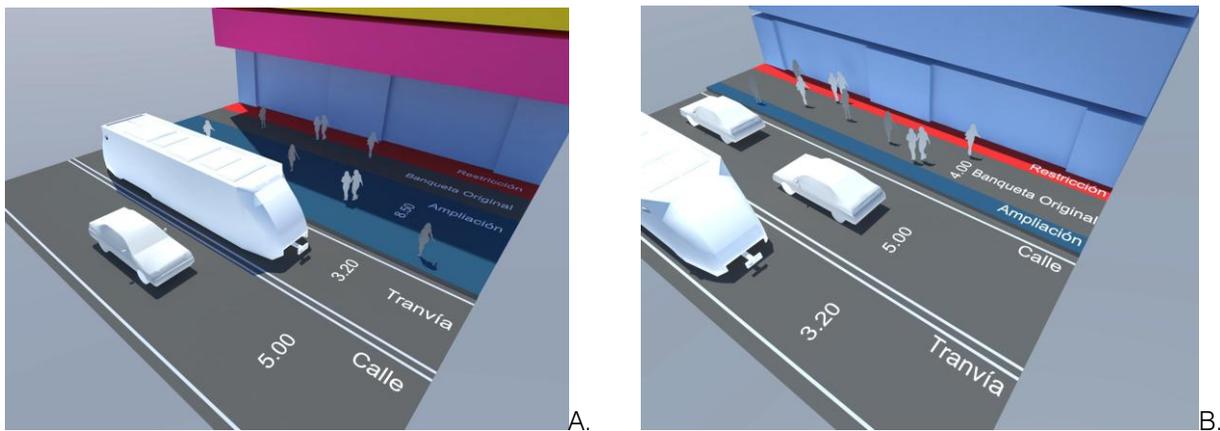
A. Imagen de las nuevas restricciones sobre la banqueta poniente. B. Imagen de las nuevas restricciones sobre la banqueta oriente.
